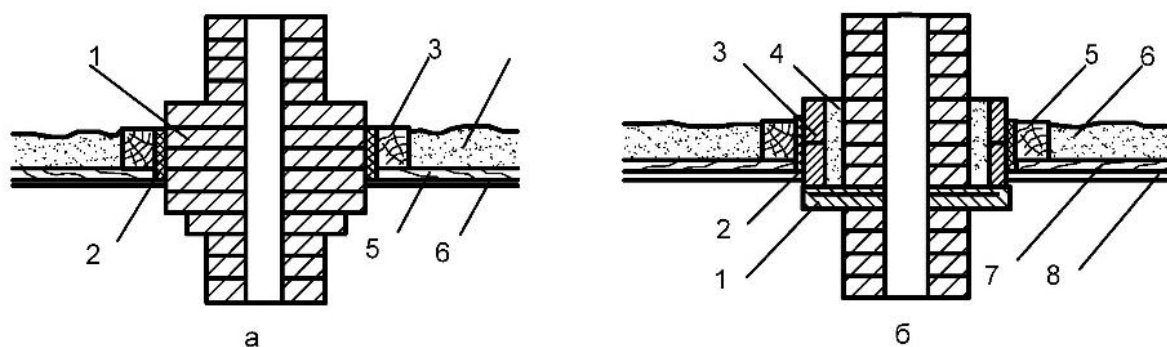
Устройство противопожарной разделки у дымовой трубы в уровне чердачного или междуэтажного перекрытия:
